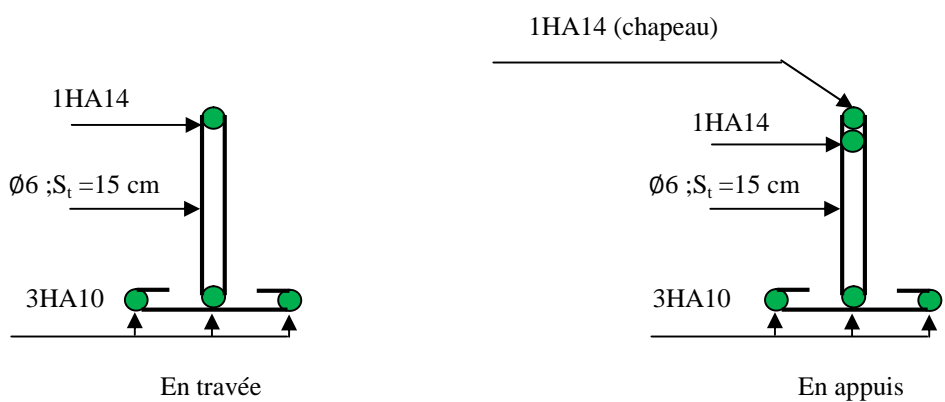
Schéma de ferrailage des poutrelles terrasse accessible.
